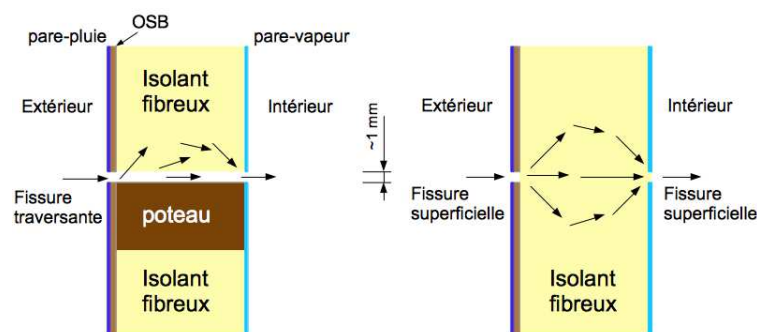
Configurations de défauts ciblés: fissure traversante et fissures superficielles.
